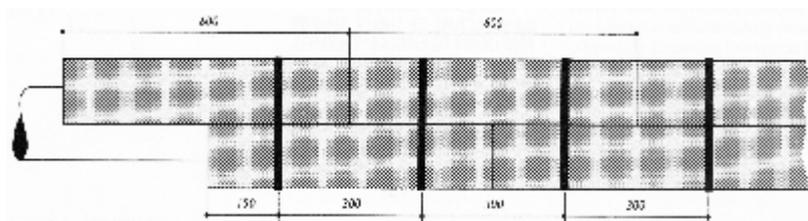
Asegure las coquillas con abrazaderas de acero inoxidable, empleando dos en cada sección estándar (600 mm).
